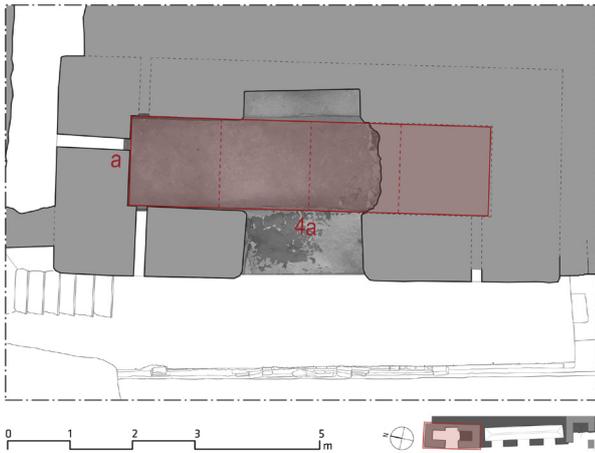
Planta del Cuarto 1 con el estudio de las proporciones.
